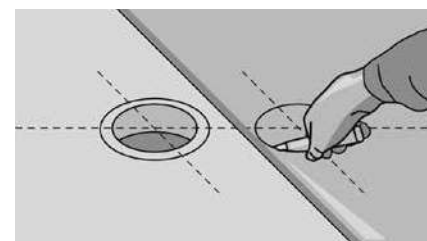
Рядом с водосточной трубой, отогните покрытие от трубы. Сделайте пометку на покрытии, где находится середина трубы. Вырежьте на отогнутом покрытии отверстие. Нагрейте виниловое покрытие и прижмите его к трубе. Обрежьте излишки крючковым ножом так, чтобы стенки трубы были закрыты.
